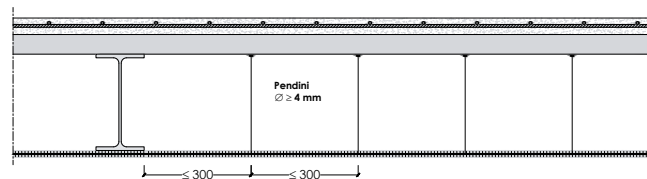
Schema di applicazione orizzontale continua (applicazione a plenum)
